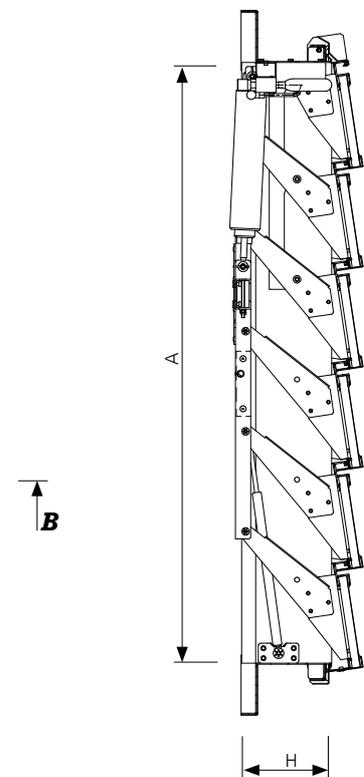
Schnitt A-A durch einen Lamellenlüfter mcr LAM in geschlossener Position (Fassadeneinbau)
